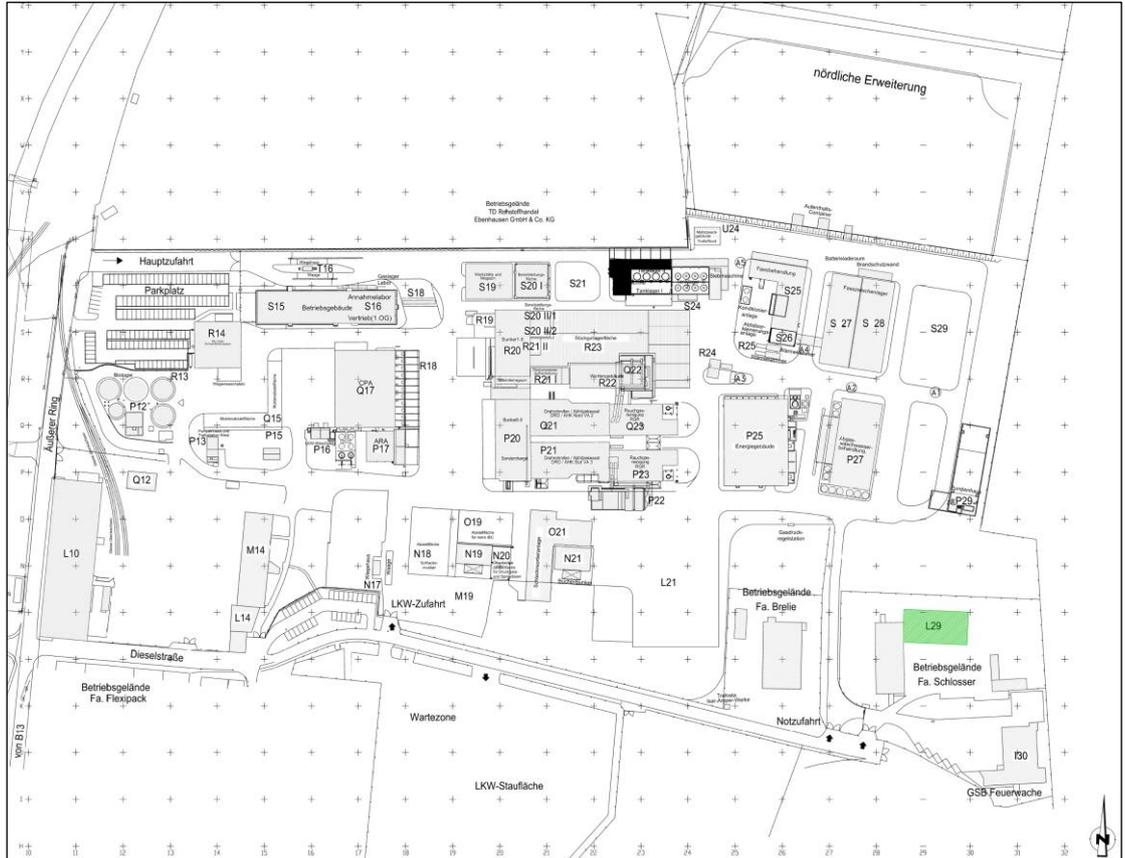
Lageplan der geplanten Stückgutlagerhalle L29 (Quelle: IA-Tech GmbH)
